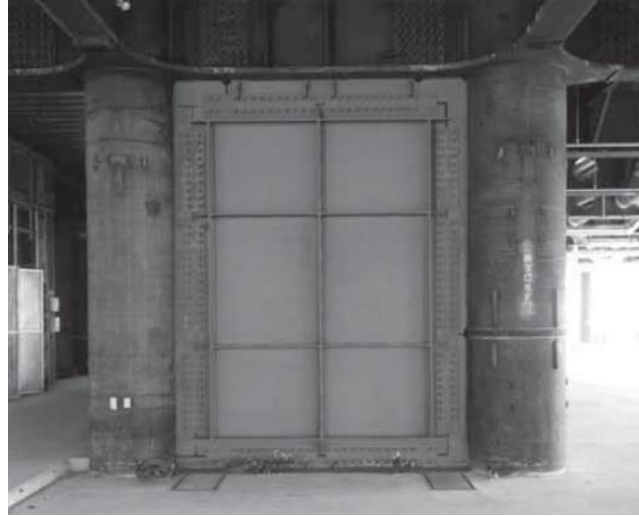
Muro de acero con rigidizadores verticales y transversales usado en Japón. (Fuente: Extracto de la Fig. 1-1. de la guía de diseño 20 Steel Plate Shear Wall, AISC 2006)
